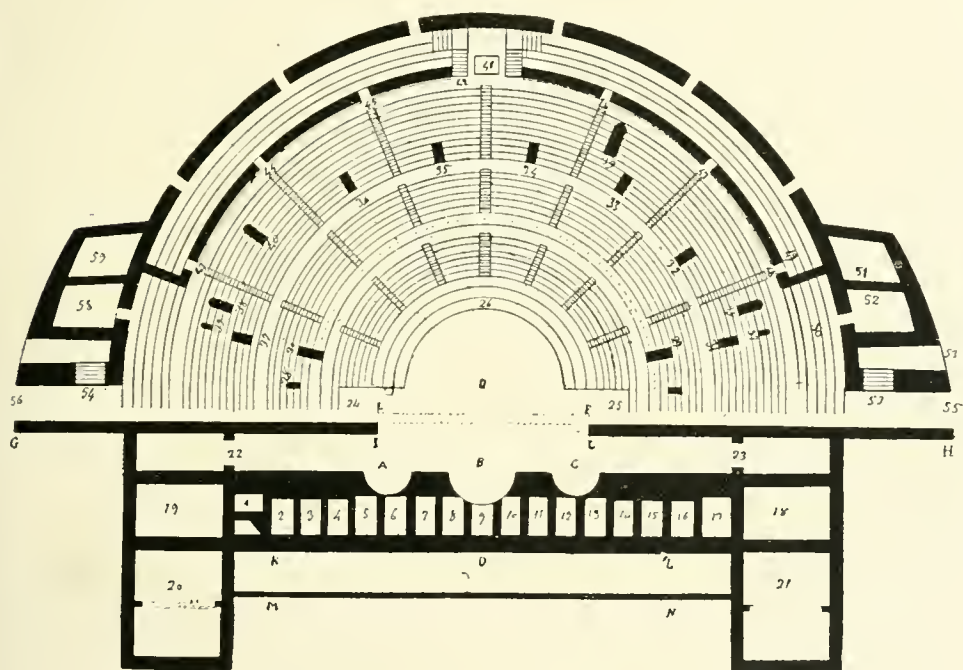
Teatre de Sagunte. Plan segons Chabret
